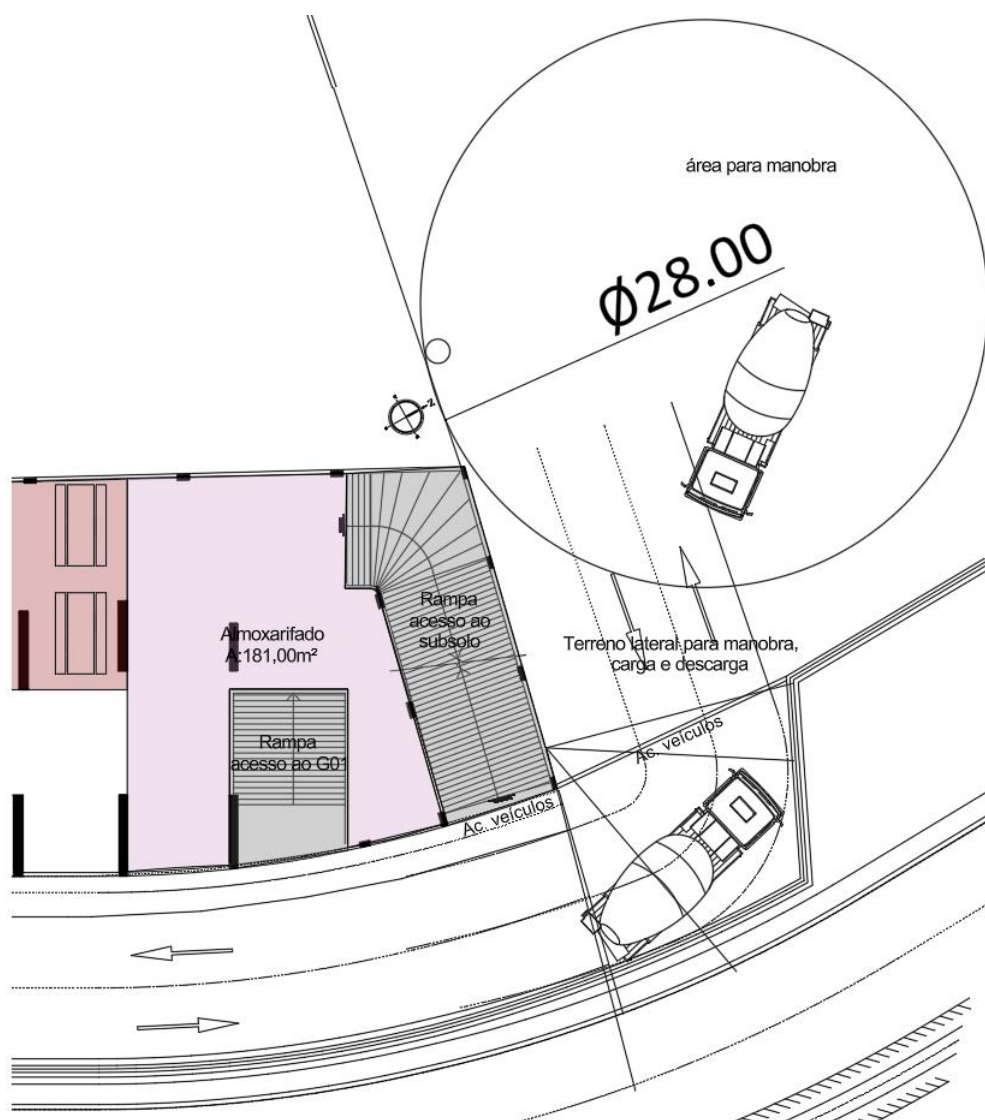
Planta do terreno lindeiro utilizado para as manobras dos caminhões de carga e descarga
